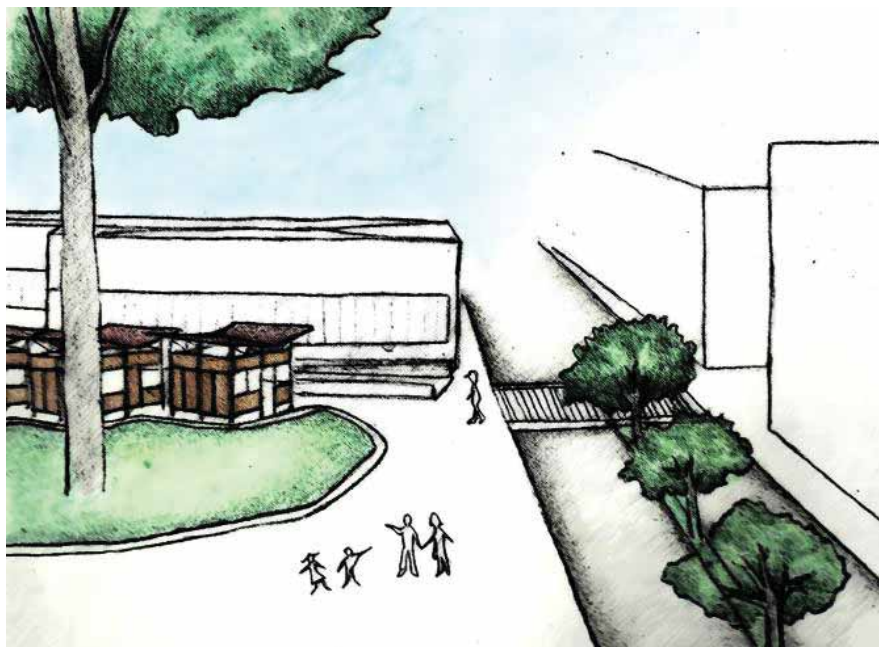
Canteiro central da Av. Brasil e faixa de pedestres elevada
